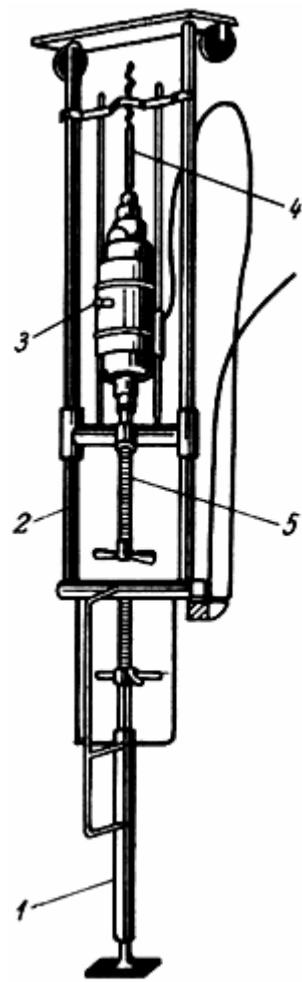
Устройство для создания давления на сверло при сверлении отверстий в стенах и перекрытиях
